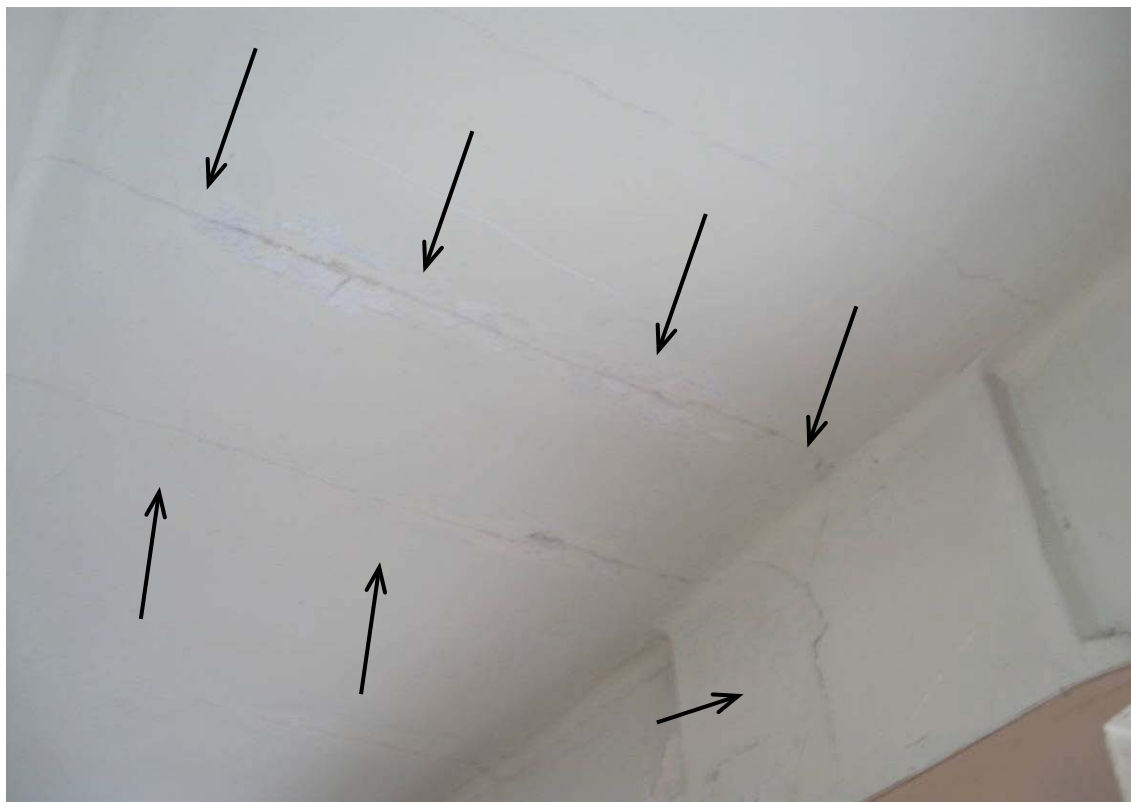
Освидетельствование плит перекрытия над балконом в осях А – Б по осям 3/1 и 3/. выявлены трещины в швах между плитами и участки выпадения раствора заделки рустов, переходящие в стены
